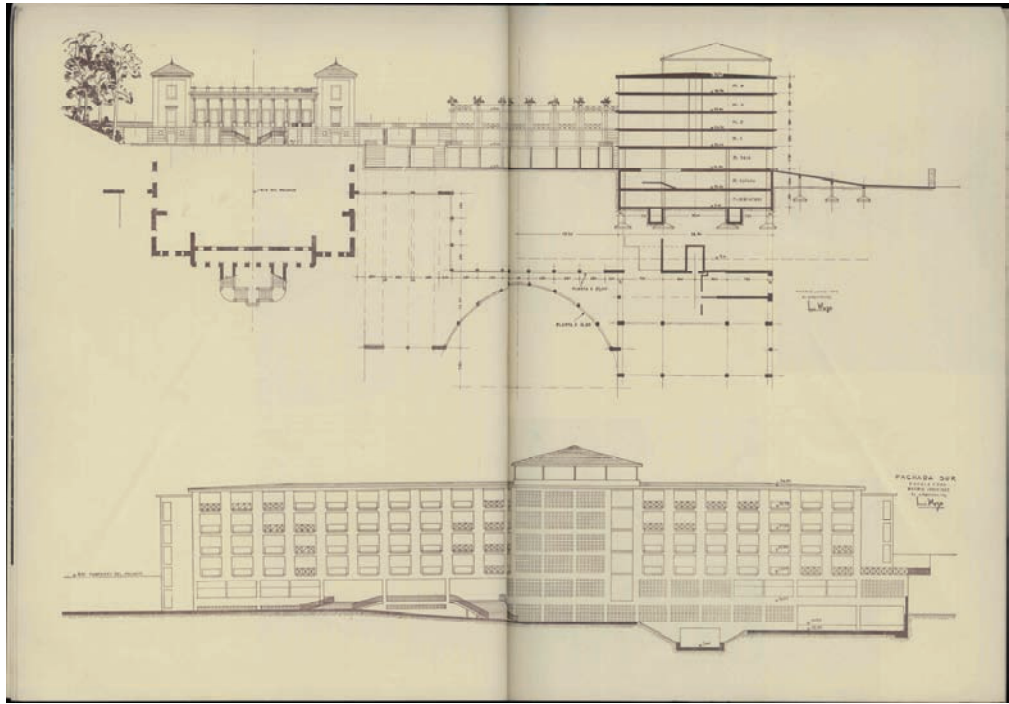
Alzado-sección oeste y planta. Alzado del bloque de habitaciones.
